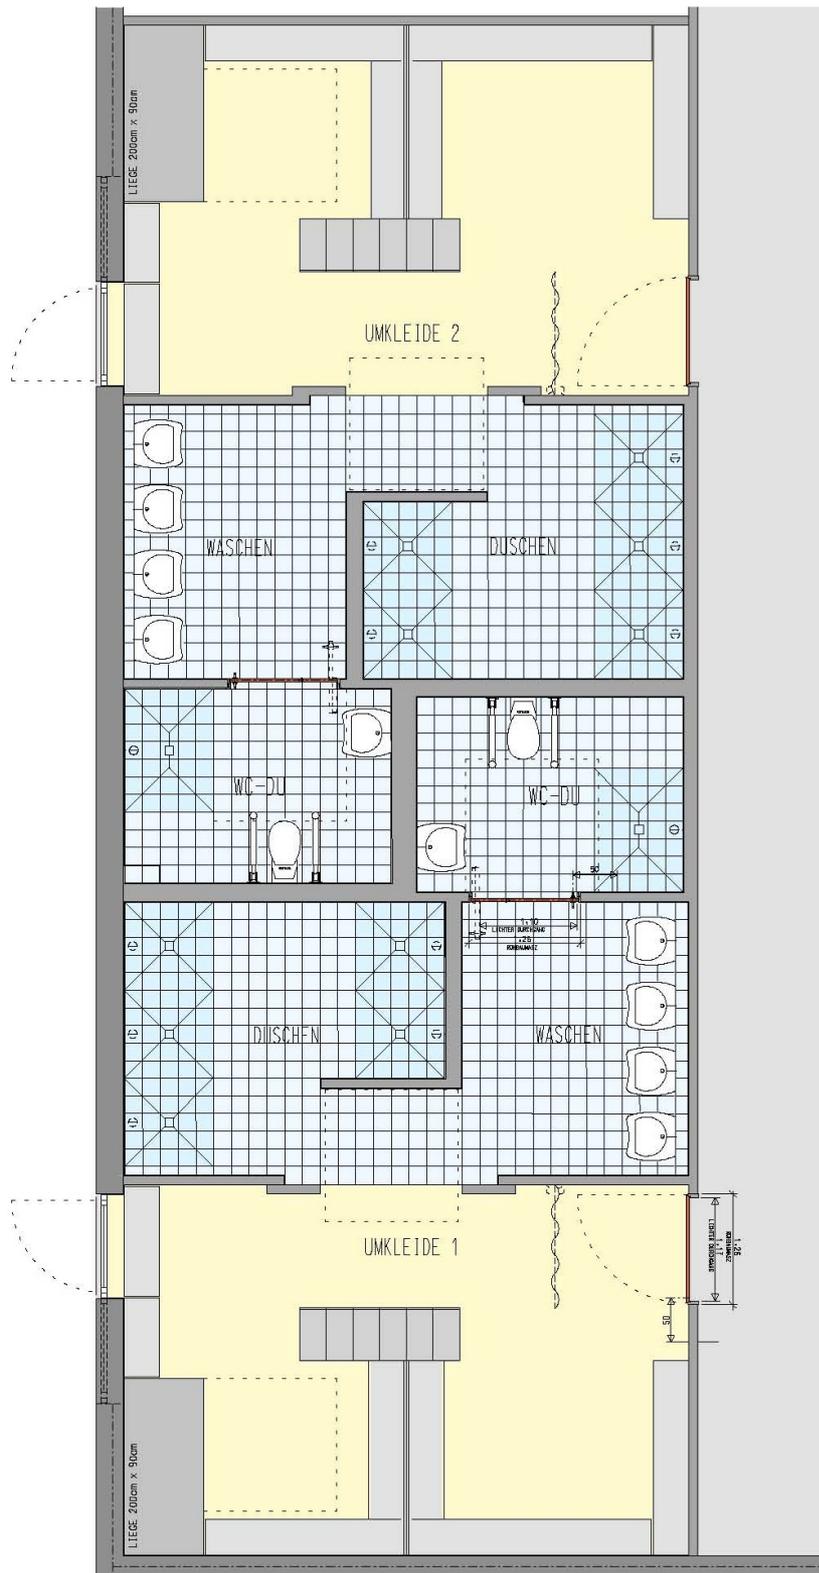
Beispiel: Einfach-Sporthalle nach DIN 18032-1 und DIN 18040-1 mit zwei Raumeinheiten Umkleide und Sanitärblock (Dipl.-Ing. M. Bruckner).
